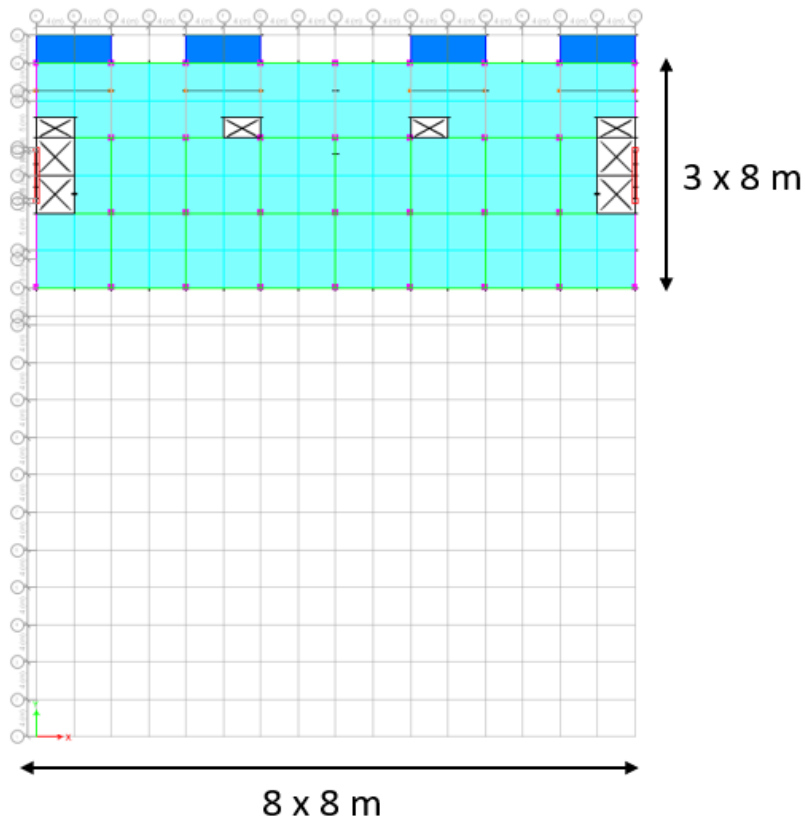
Denah Tipikal Lantai 8 dan 10 Untuk Model 2
